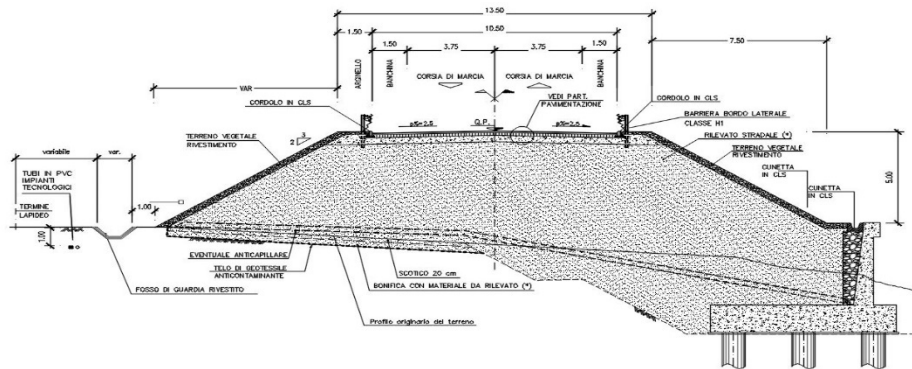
Sezione tipo in rilevato asse principale con muro di sottoscarpa
